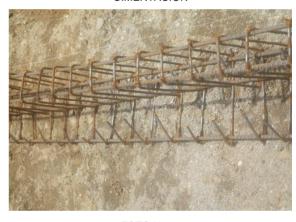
ARMADO DEL ACERO TIPO L DE CIMENTACION
